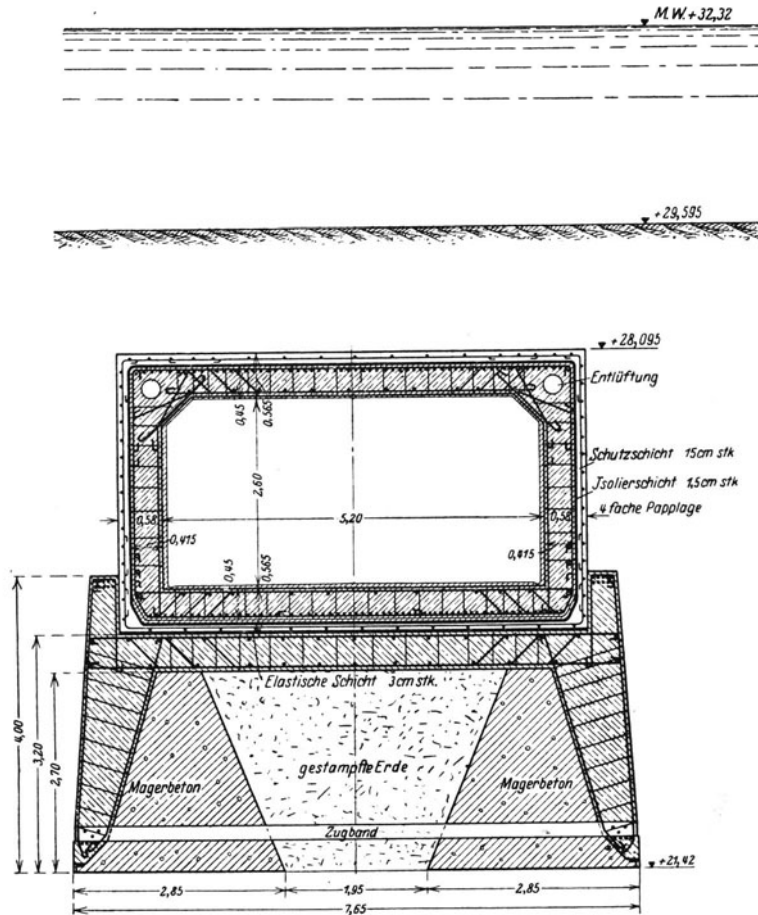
Querschnitt des Fußgedrükers. (Nach La Baume: Bautechnik 1928 S. 41.)
